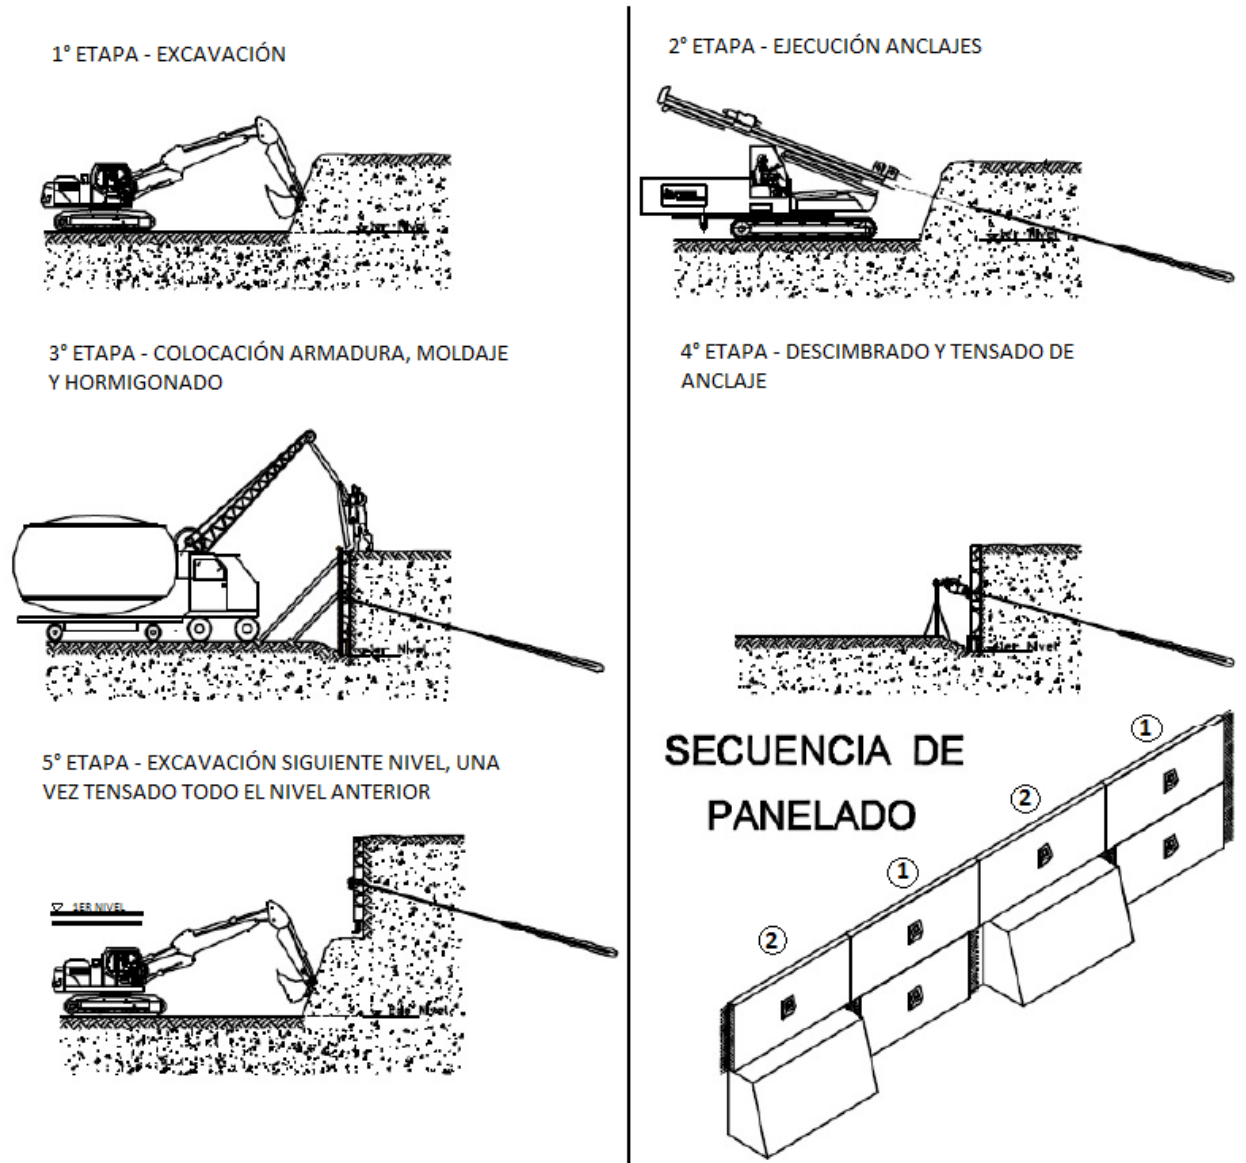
Proceso constructivo Muro Anclado de Hormigón Armado. Cabellos (2012).
